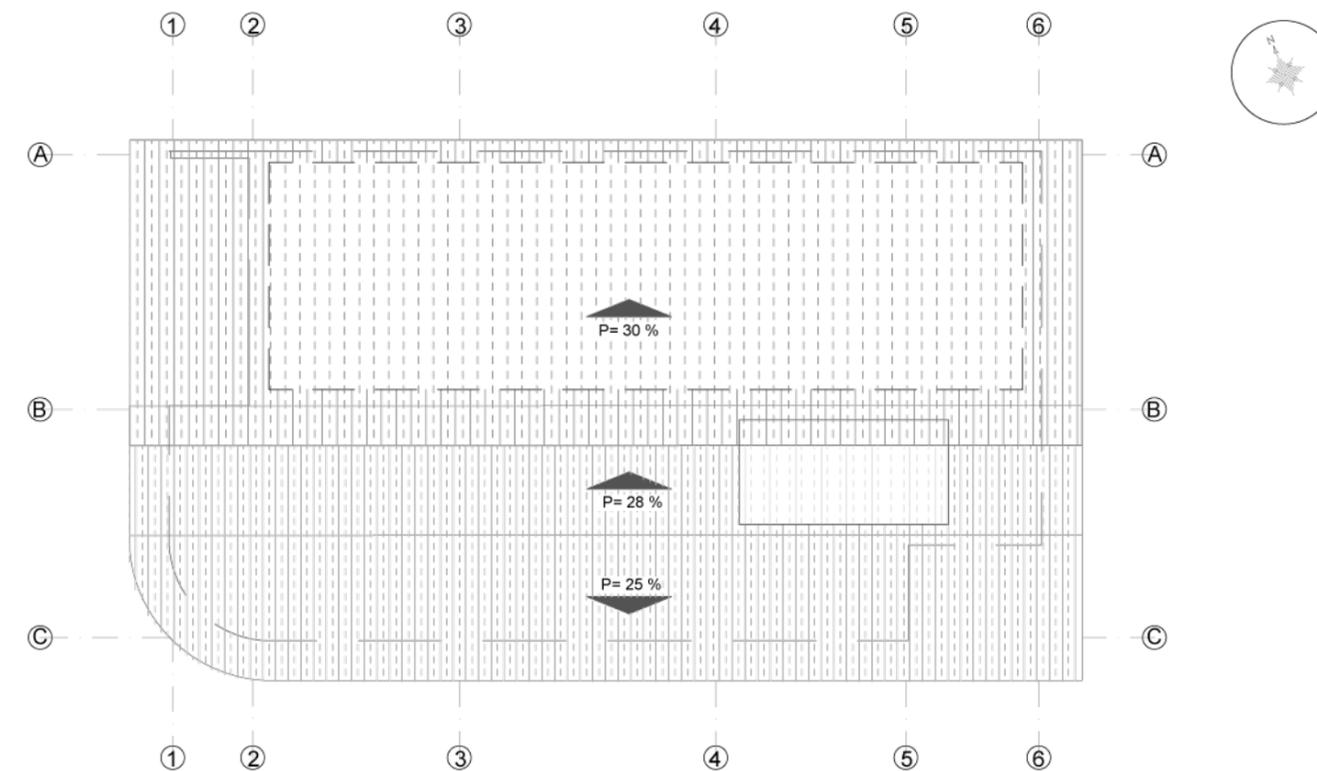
PLANTA PROPUESTA GENERAL
